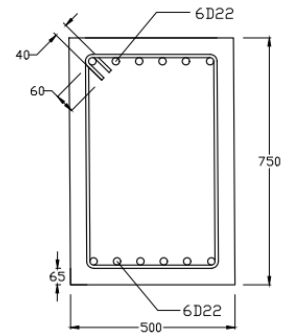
Detail Potongan Tampak Samping *Pilecap Balok
